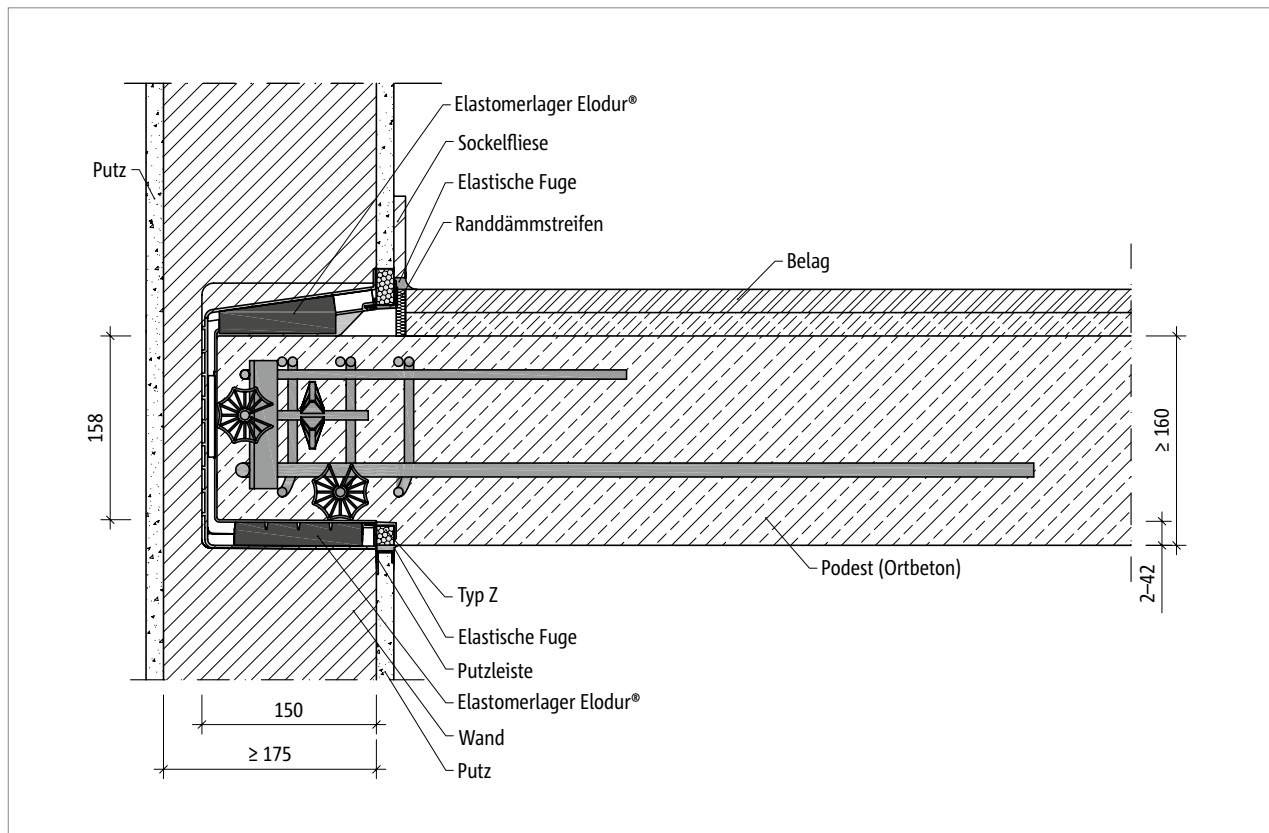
Tronsole® Z-V+V-T-V1: Einbauschnitt Ortbetonpodest
